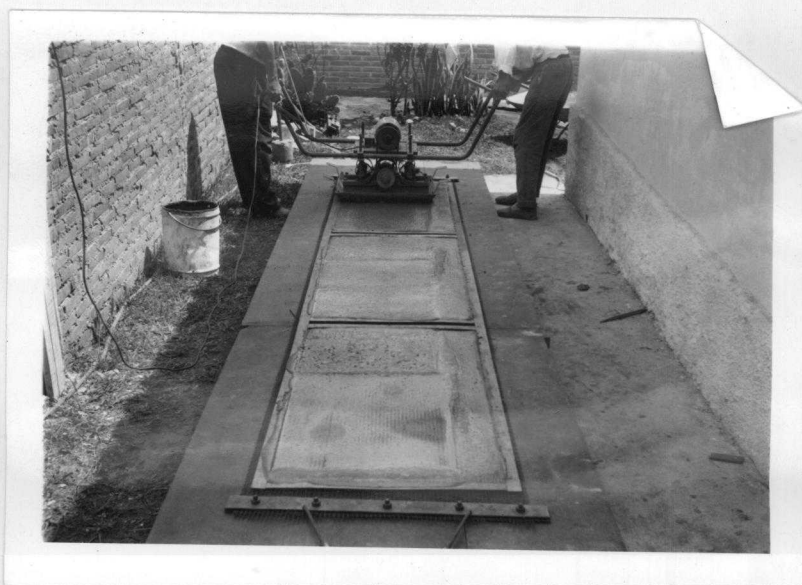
Adensamento da argamassa com vibrador de placa. O sistema utilizado dá grande rendimento na pré-fabricação.
